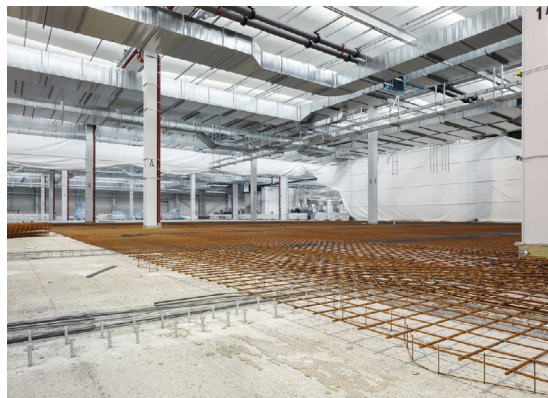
Підсилення/реконструкція бетонного шару методом нарощування (схема)
